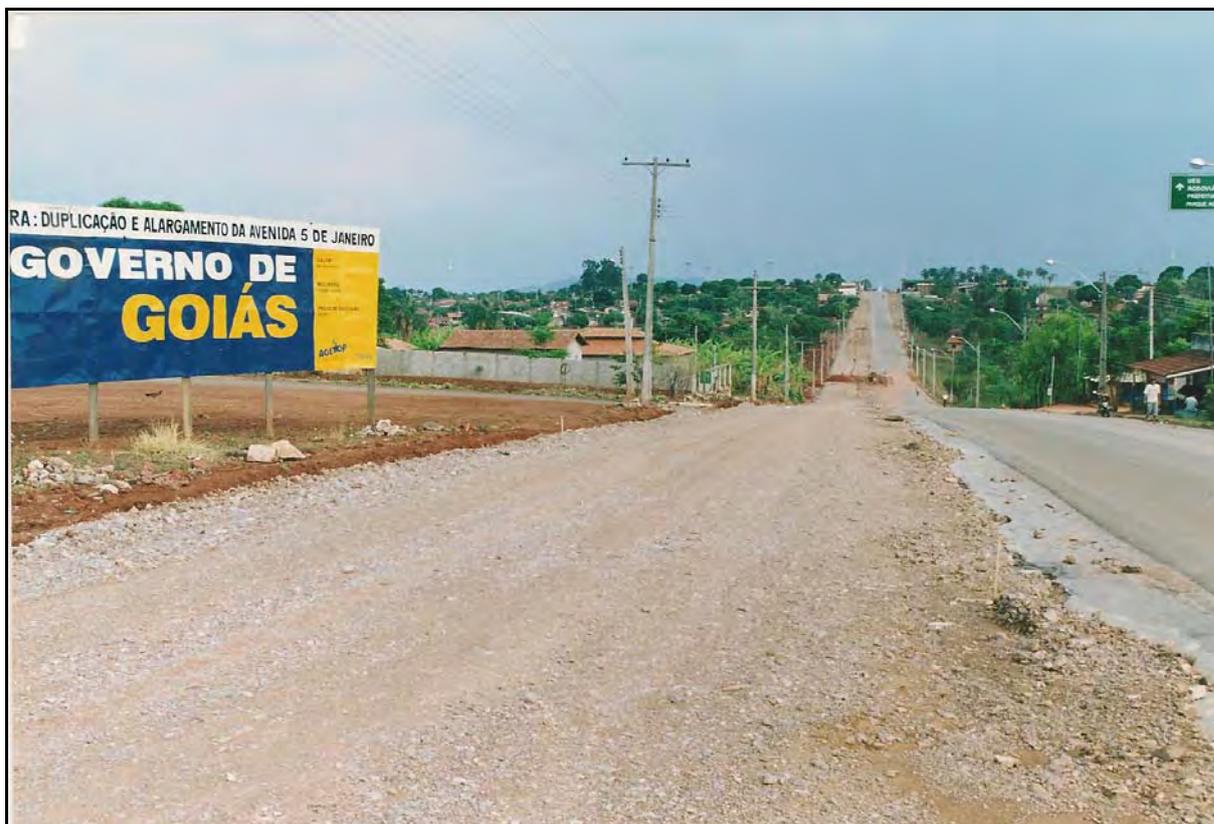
Sanclerlândia: obras de duplicação da Av. 5 de Janeiro (GO-326) no Setor Planalto
